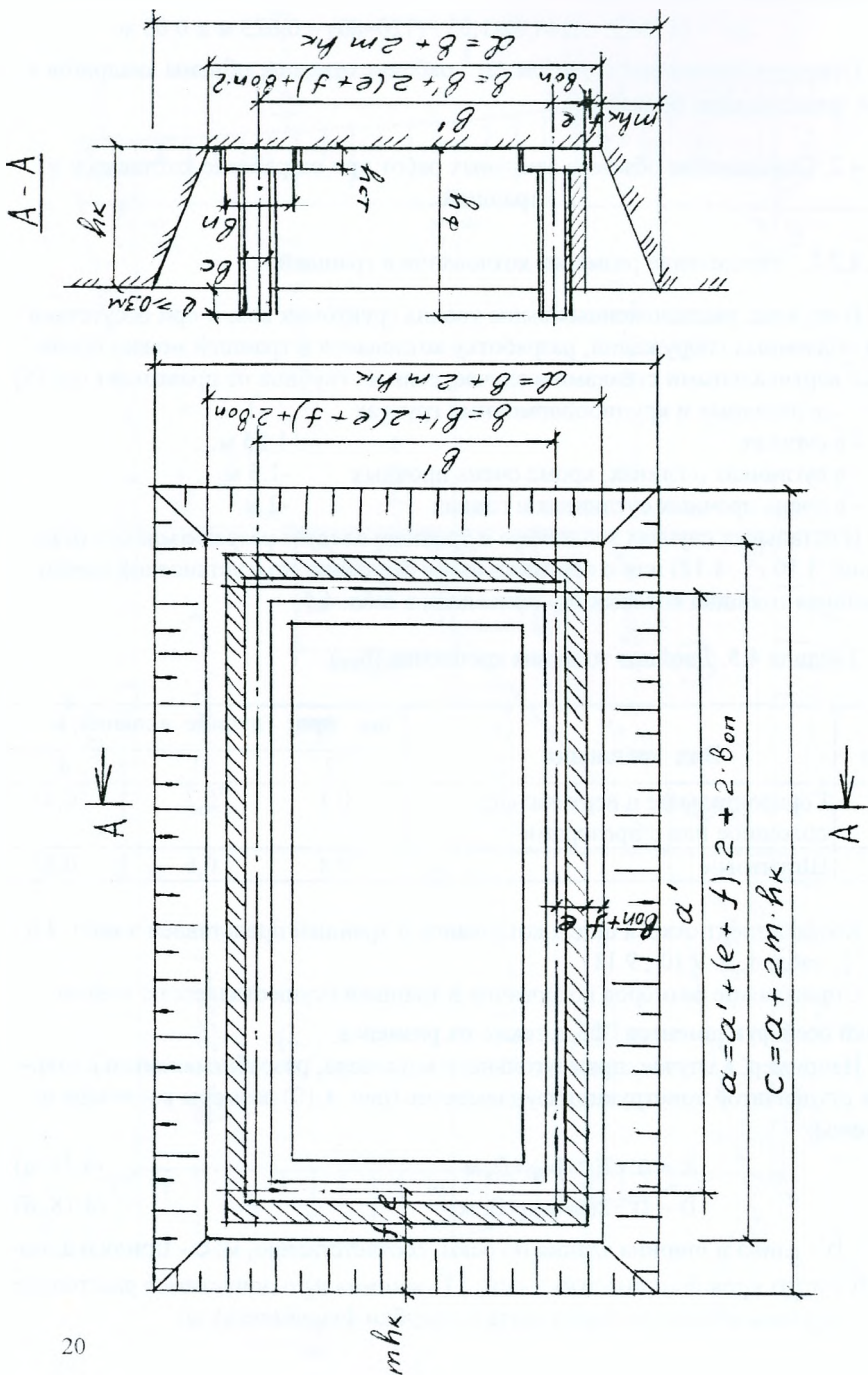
Схема прямоугольного котлована с монолитным ж/б фундаментом
